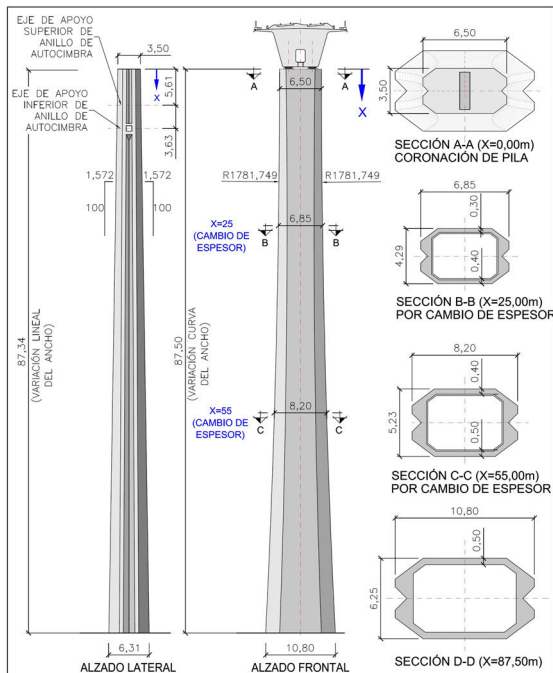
Definición geométrica, vista en alzado y vista esviada de una de las pilas.
